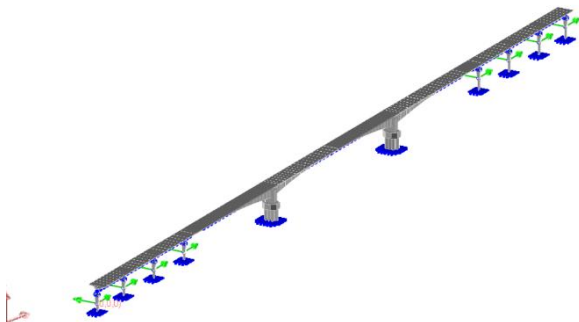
การทดสอบสะพาน(Bridge Load Testing)
